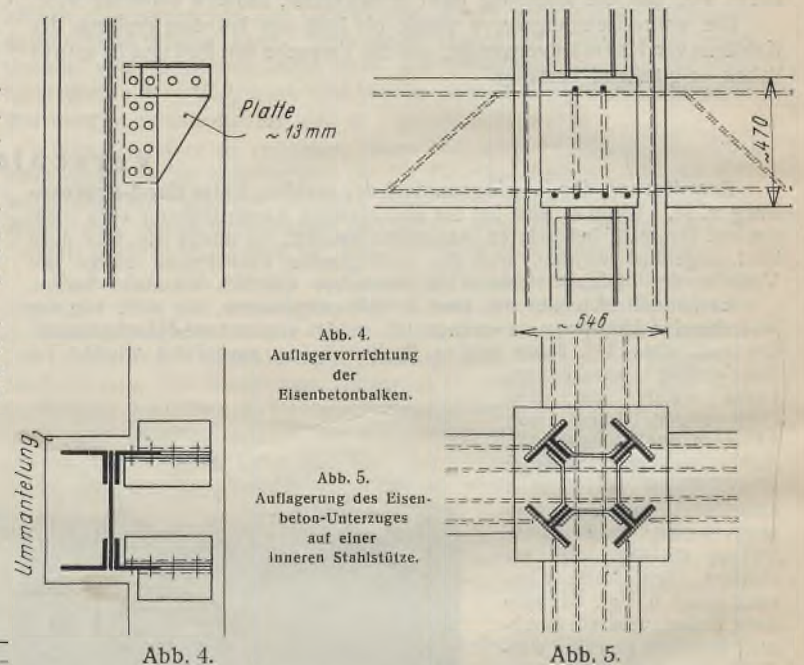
Auflageranordnung der Eisenbetonbalken.
